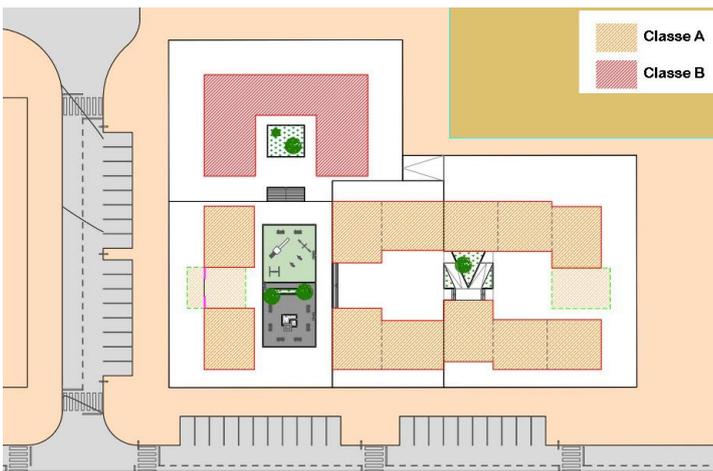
Planta de implantação do conjunto habitacional Casa Para Todos em Palmeira, Ilha do Sal
